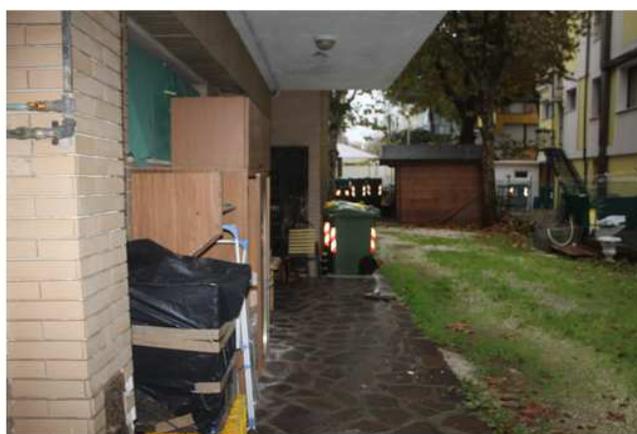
spazi esterni – lato ovest – retro dell'albergo
